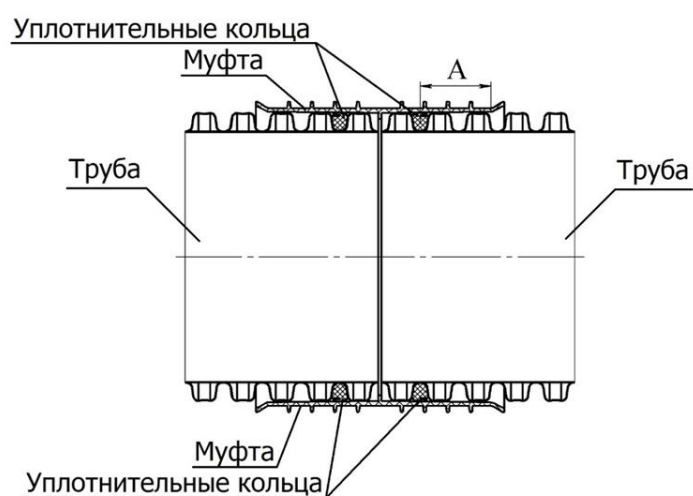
Схема соединения труб муфтой с уплотнительными кольцами.
